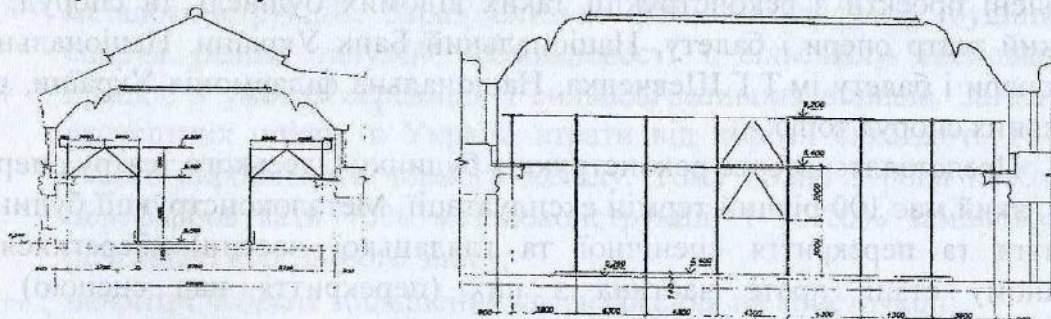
Поперечний та поздовжній перерізи будинку Національного Банку України
